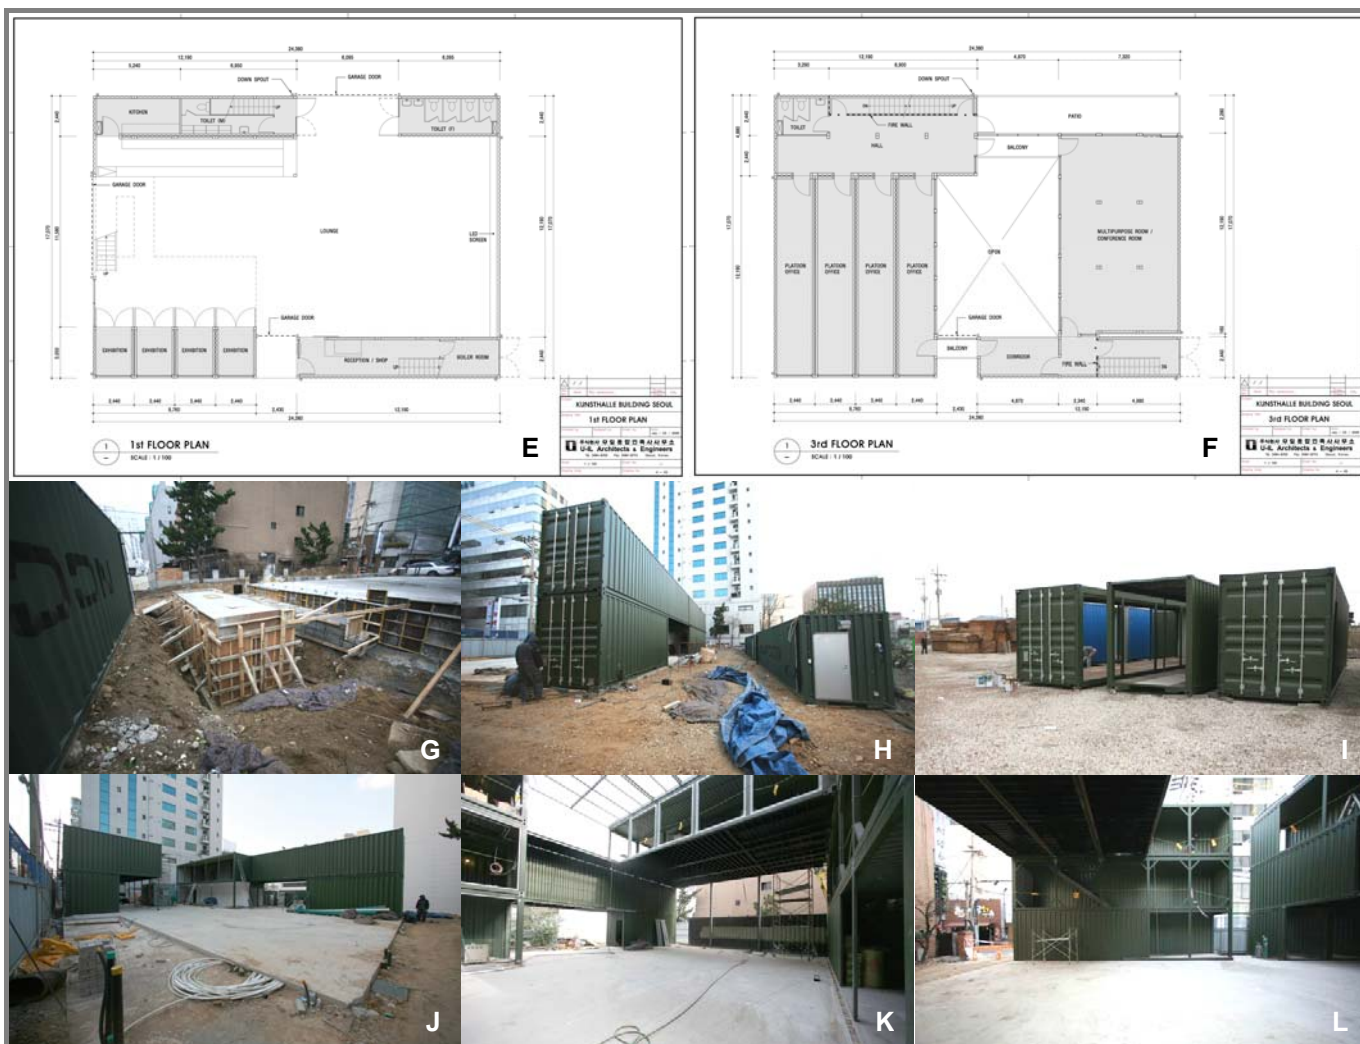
E e 19.F - Plantas (s/ escala); 19.G e 19.J - Fundações; 19.H, 19.I, 19.K e 19.L - O edifício em fase de construção. (Platoon 2009).
